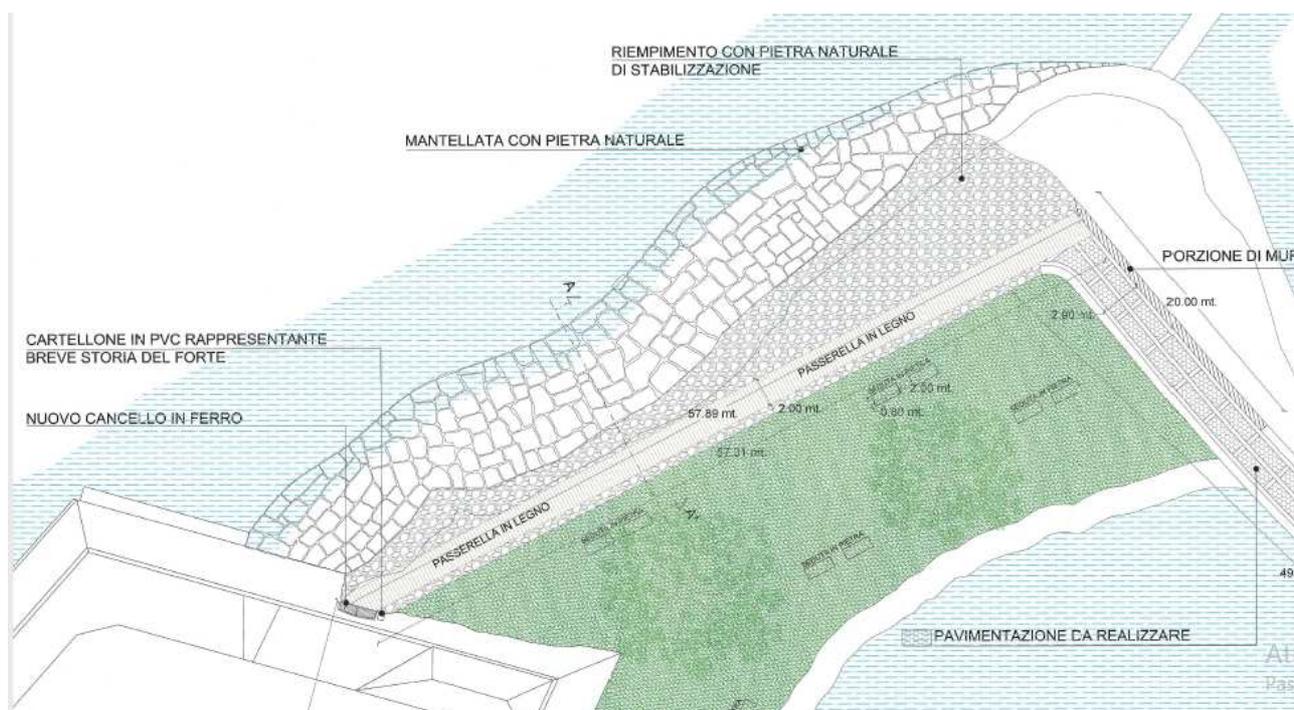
Planimetria di progetto con indicazione della mantellata da realizzare nelle aree antistanti l'ingresso del Forte Garcia.
